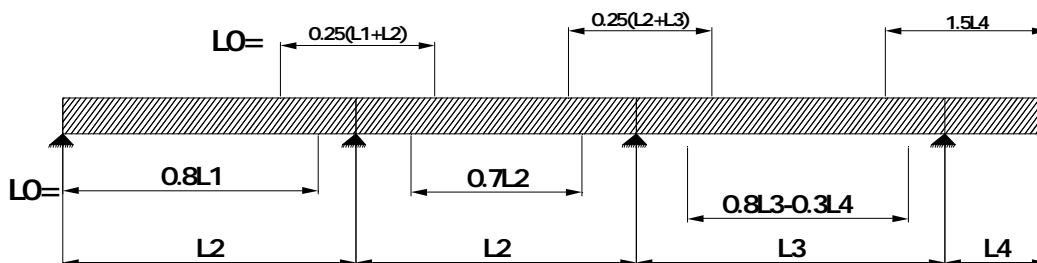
la largeur participante de la dalle dans le cas d'une poutre continue
